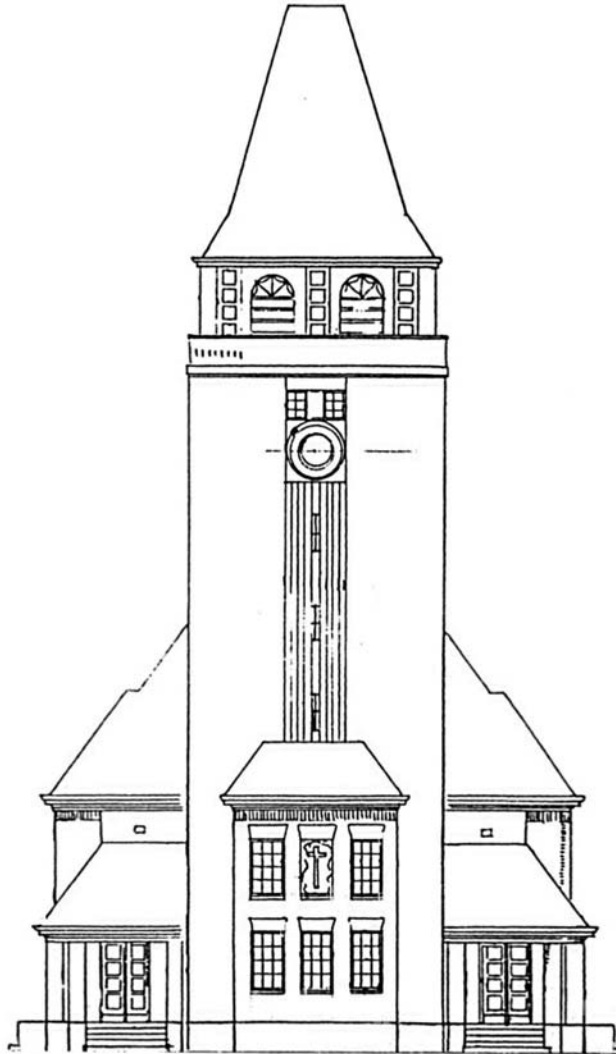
Außenansicht, Eingangsfassade, Entwurf Ludwig-Becker
